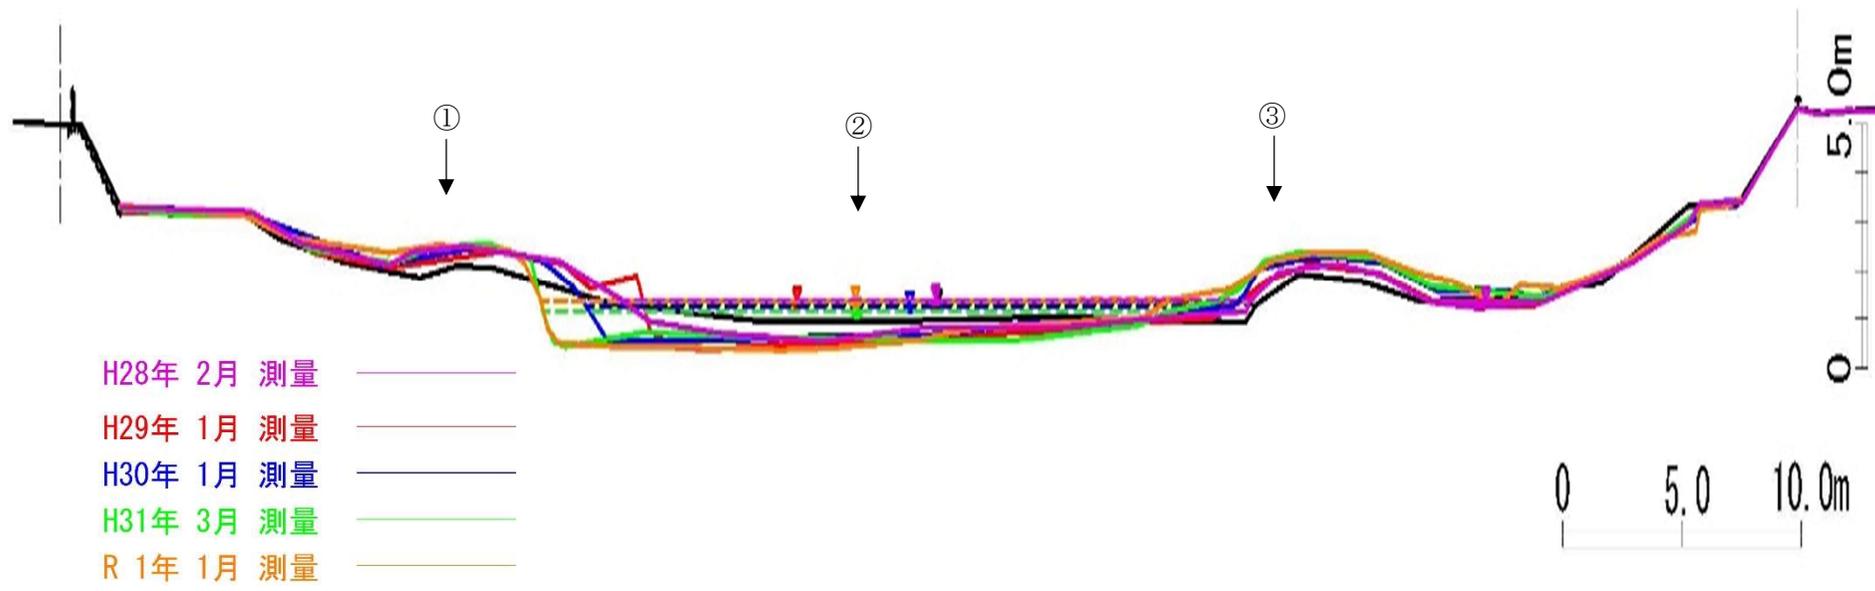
(4) 横断面图 (No. 4L, 4R)
